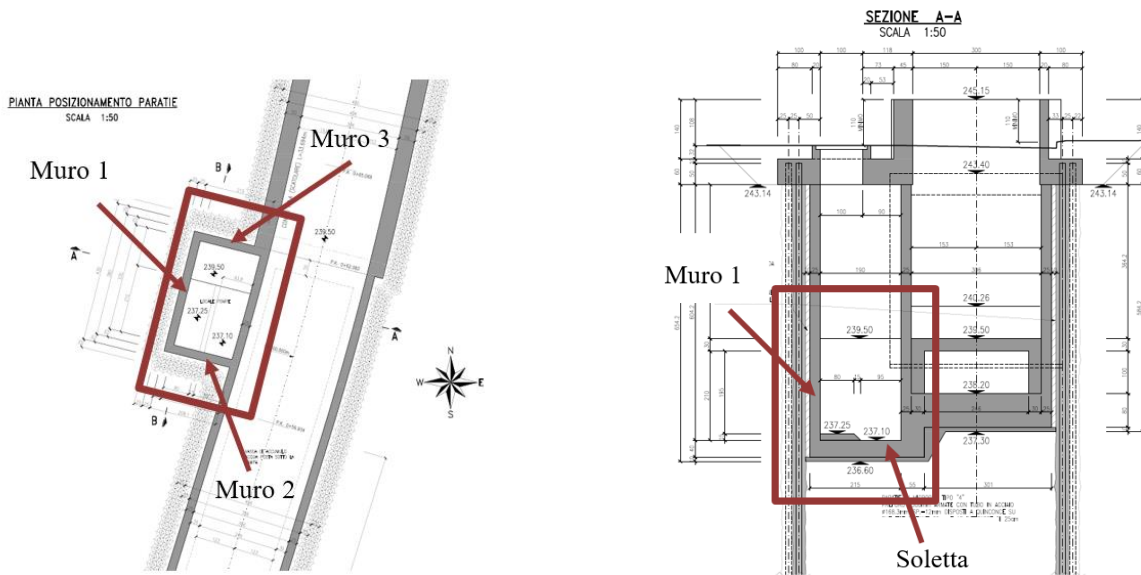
Pianta e Sezione trasversale muro di rifodera "1" e soletta del locale pompe
